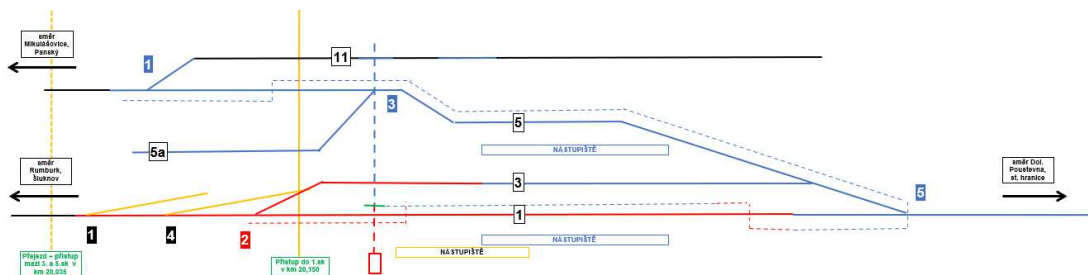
Varianta B - SP1; Zdroj: vlastní
